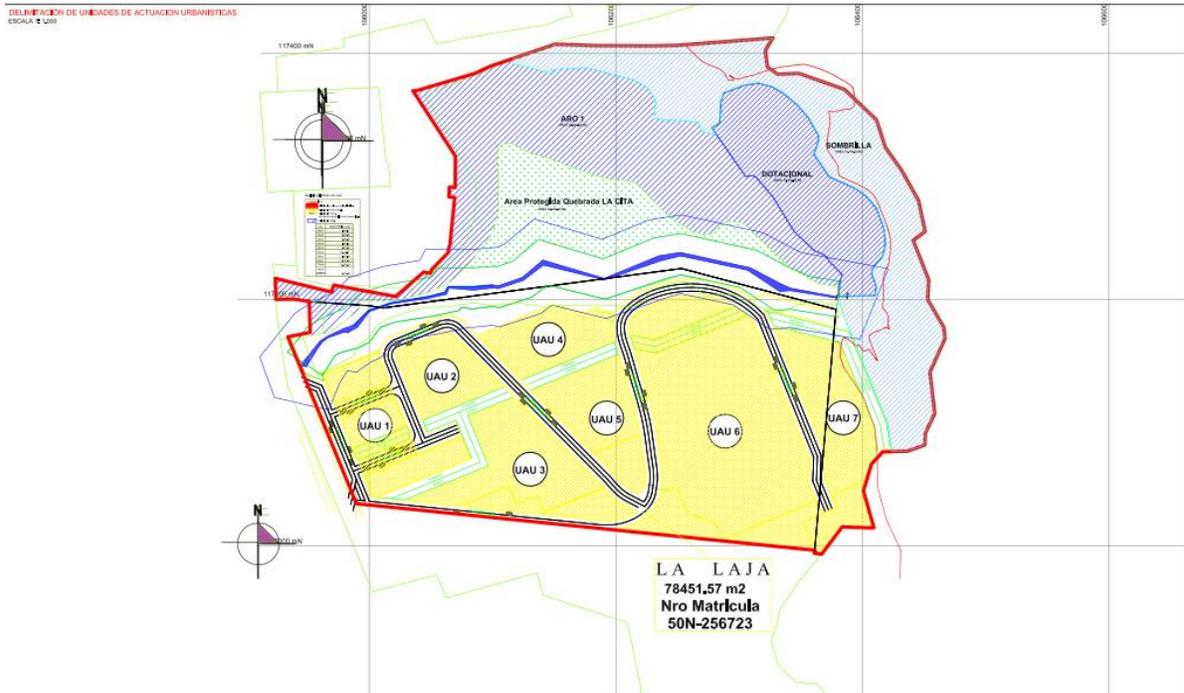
Plano UAU. PPD LA ROCA LA LAJA.
